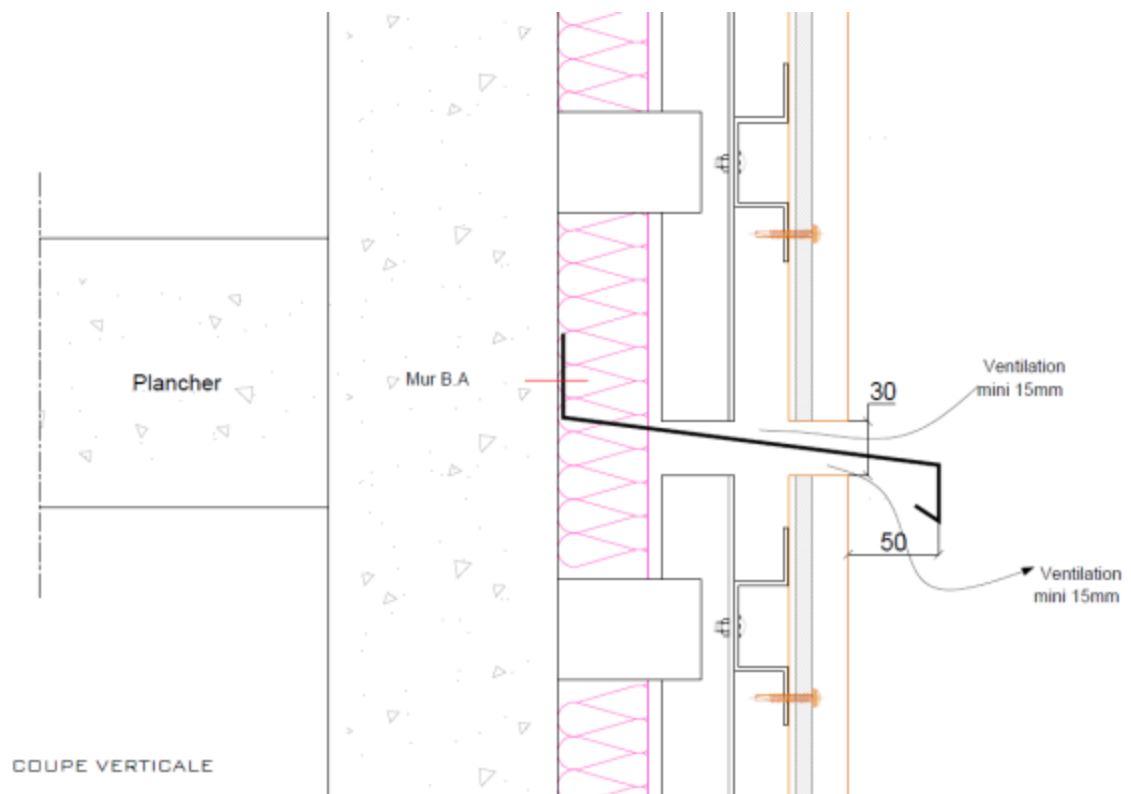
is – Fractionnement de l'ossature métallique au droit de chaque plancher sur béton
